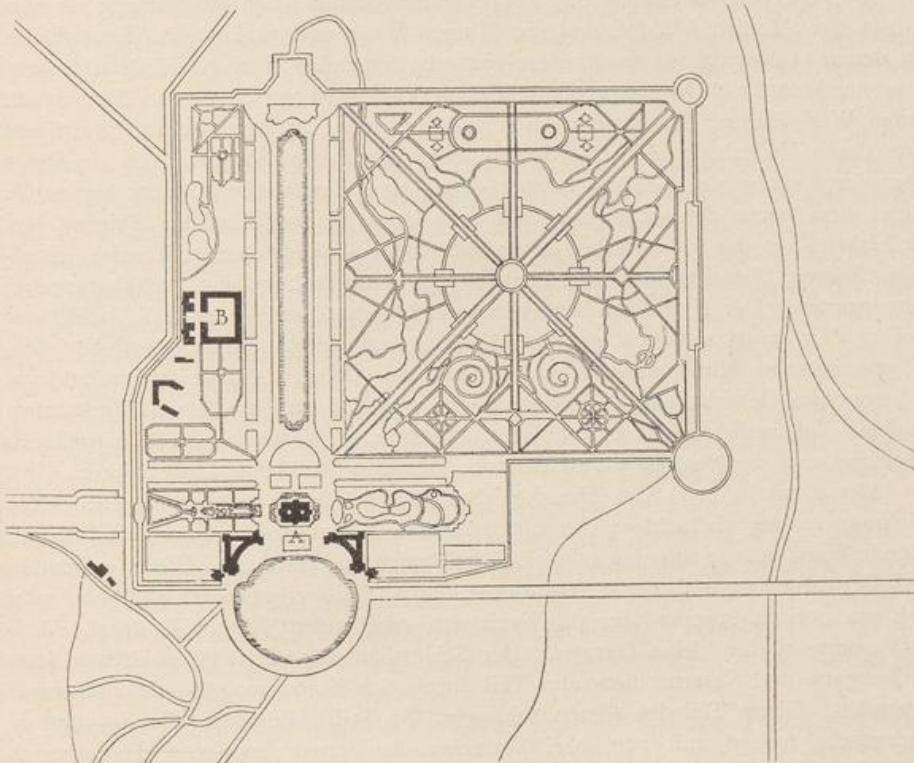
Benrath. Grundriss der Gartenanlage.
